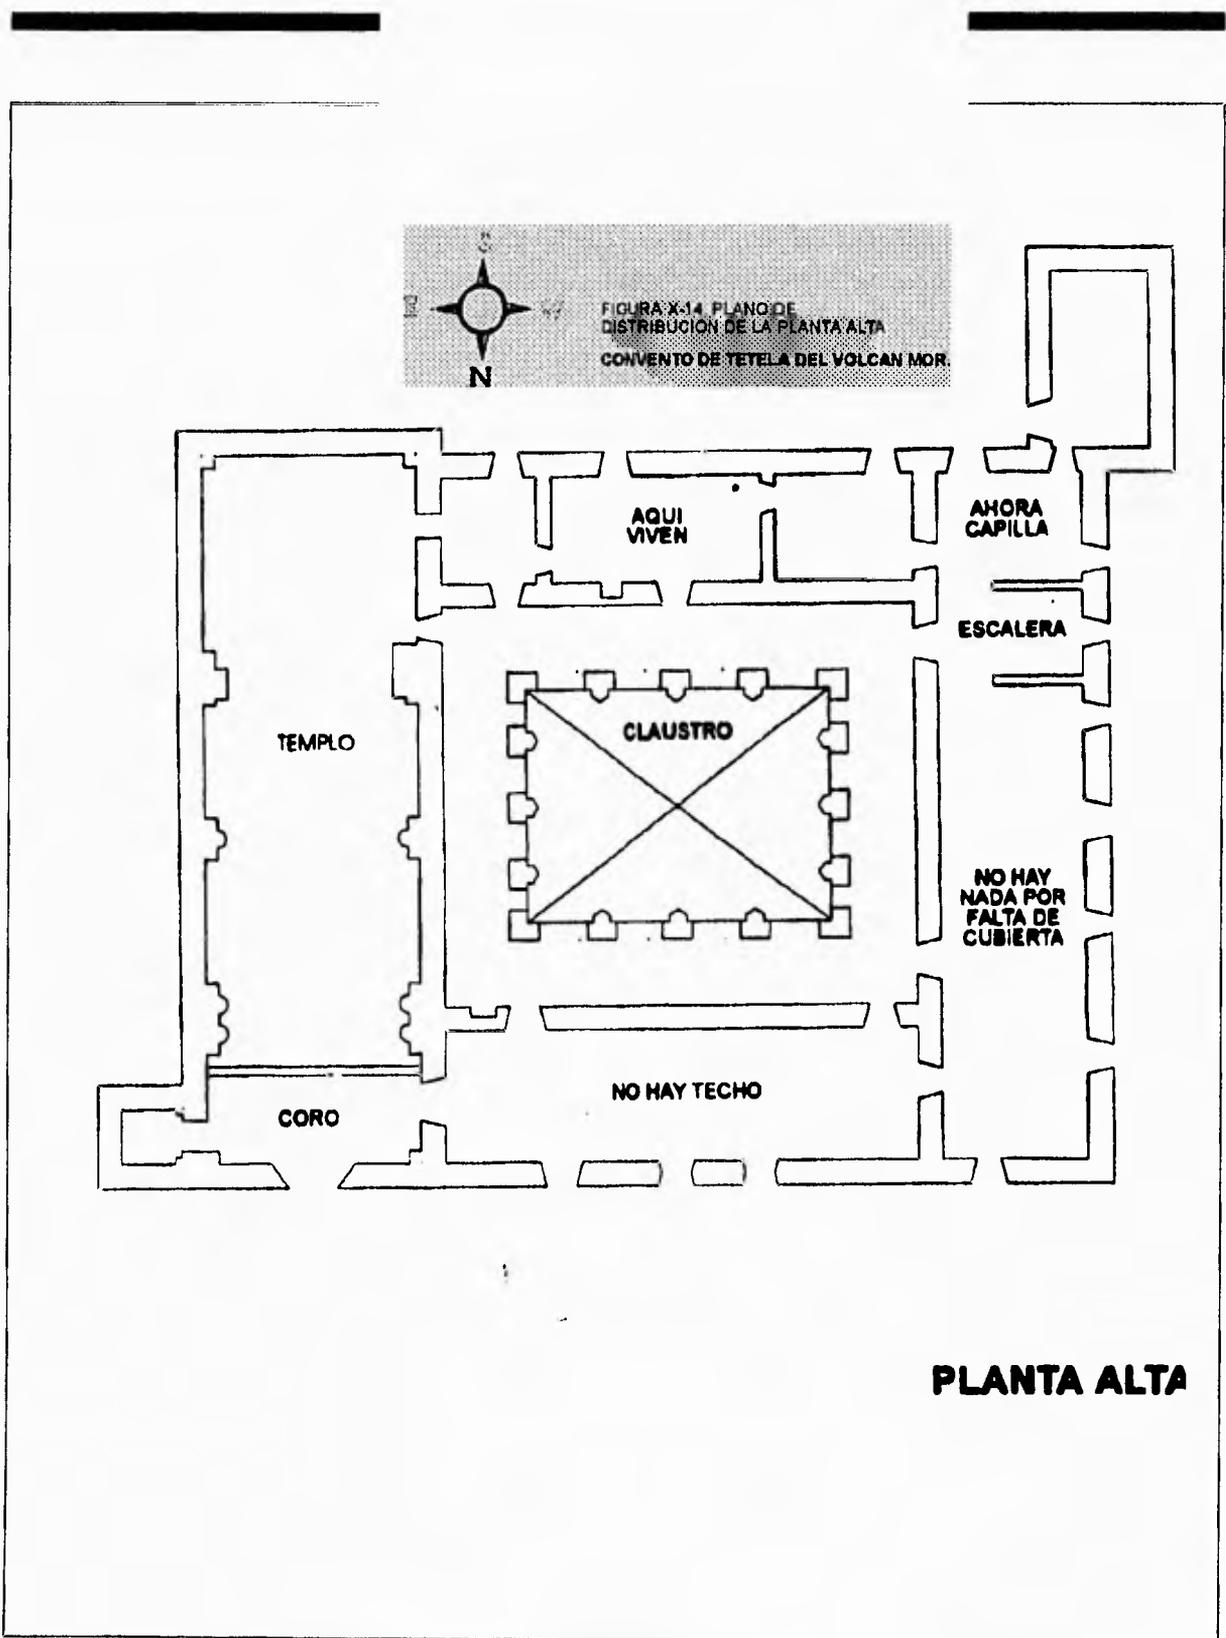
Plano de la planta alta del convento de Tetela del volcán.
